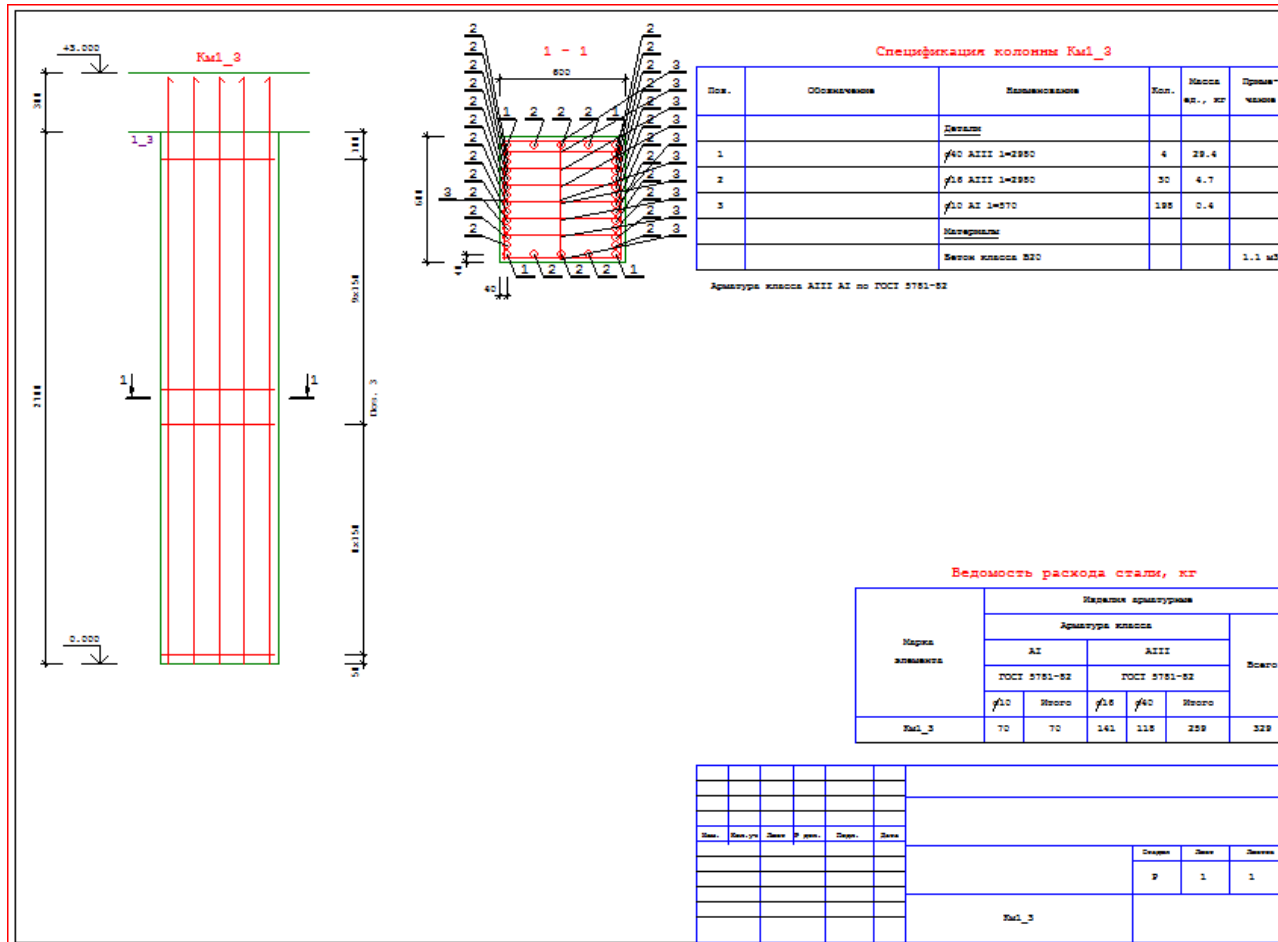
Вариант плитного перекрытия. Колонна 1-3. Кресления рабочего проекта
